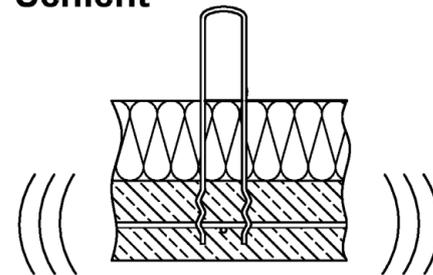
Nachverdichten der unteren Schicht (SPA-N). Einhalten der Ankerlänge im Beton gemäß Anlage 5.
